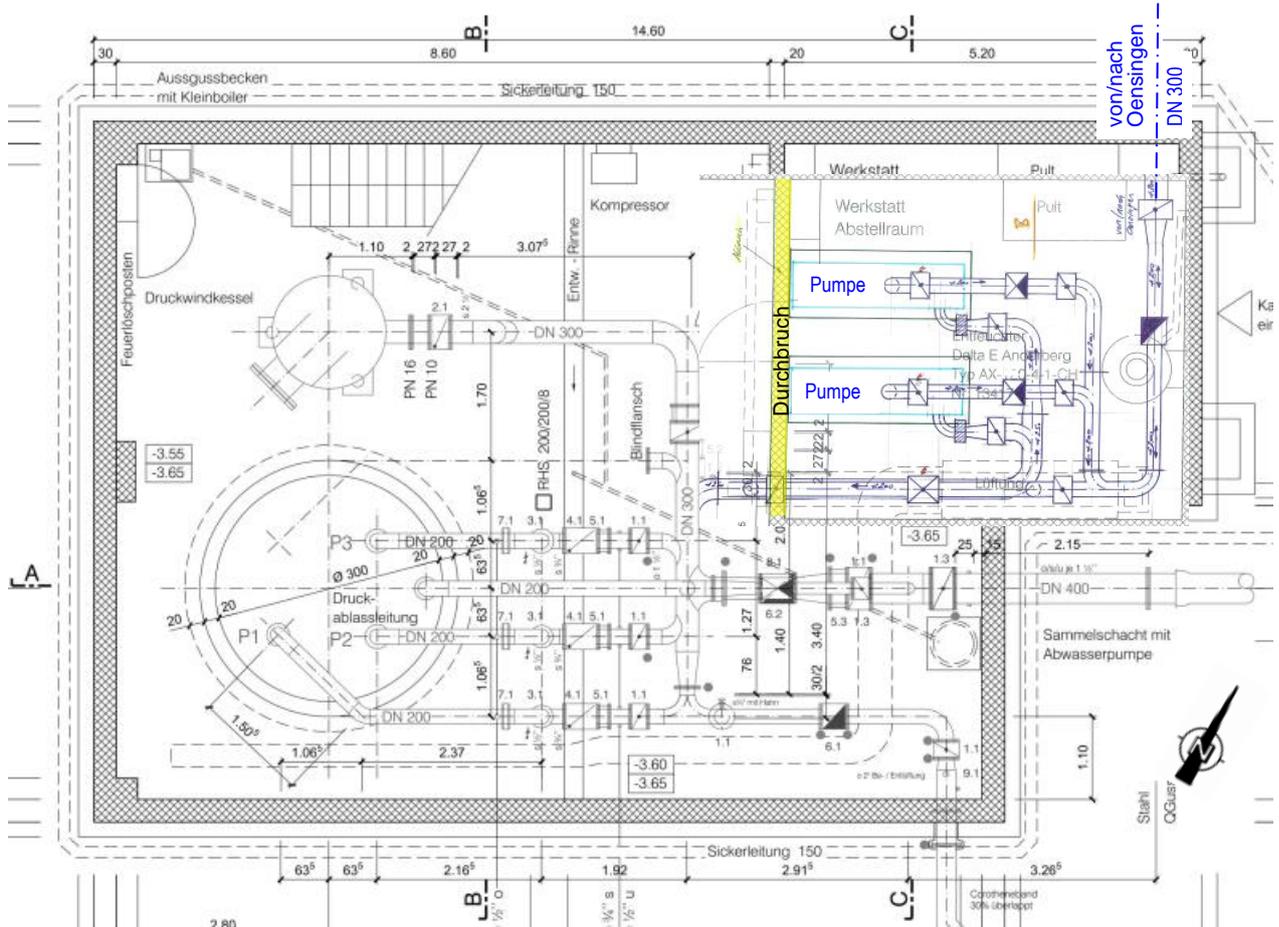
GWPW Neufeld mit Einbau Stufenpumpwerk, Grundriss 1:100
